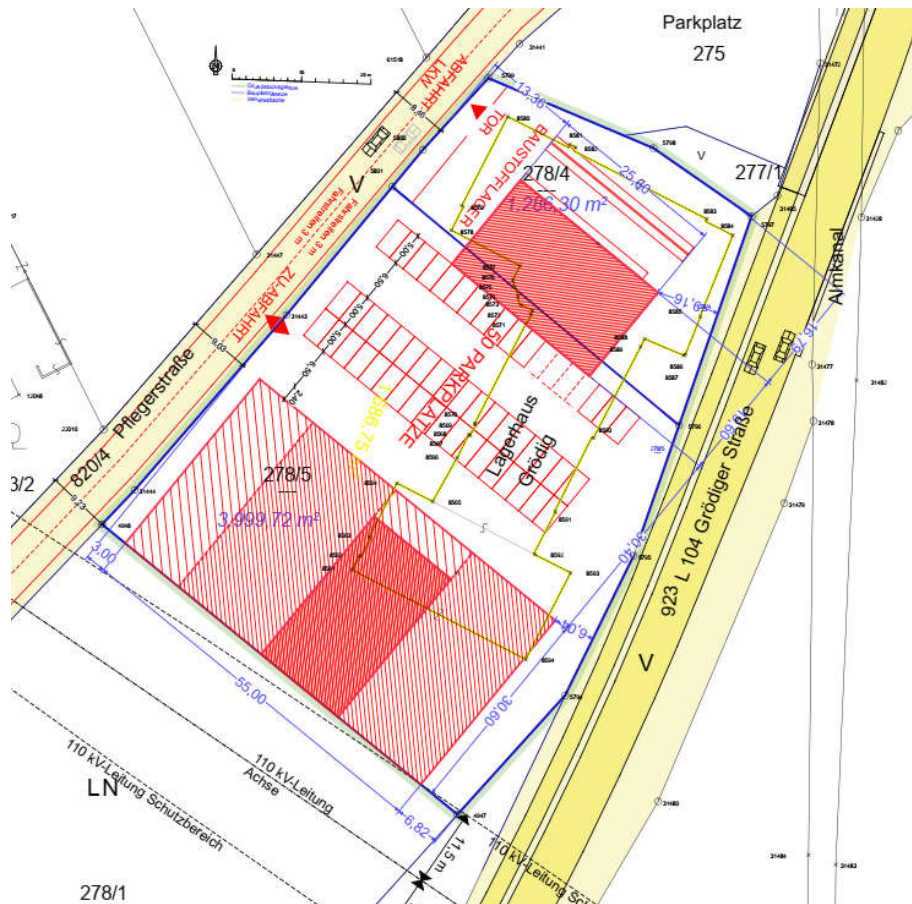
Lageplan zum Neubau des Lagerhauses mit zwei Baukörpern
